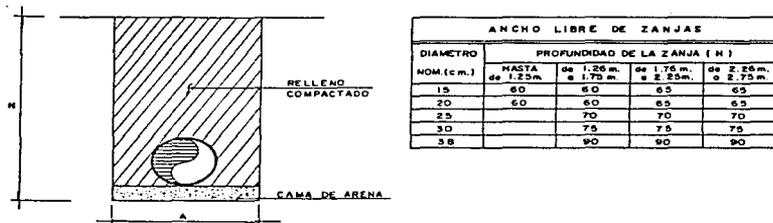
Zanja tipo excavada para la red de drenaje pluvial
